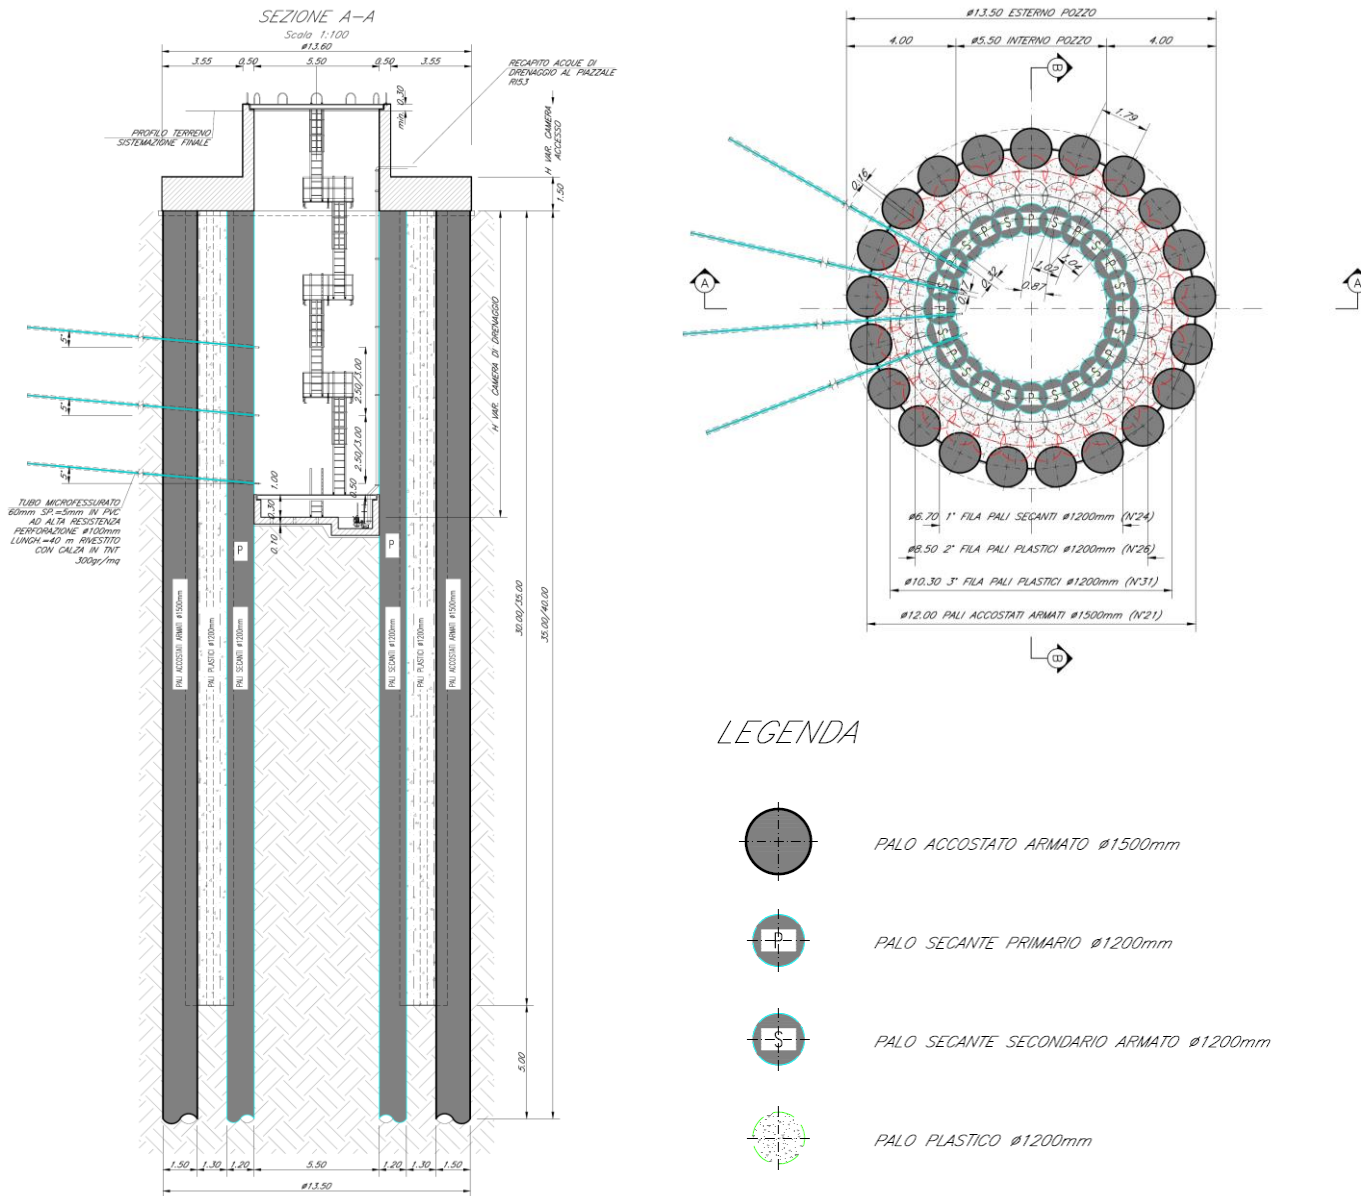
Pianta e sezione longitudinale pozzi strutturali di presidio opere di linea
